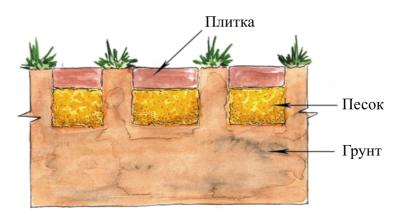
Схема устройства шаговой дорожки (второй способ) [1]
